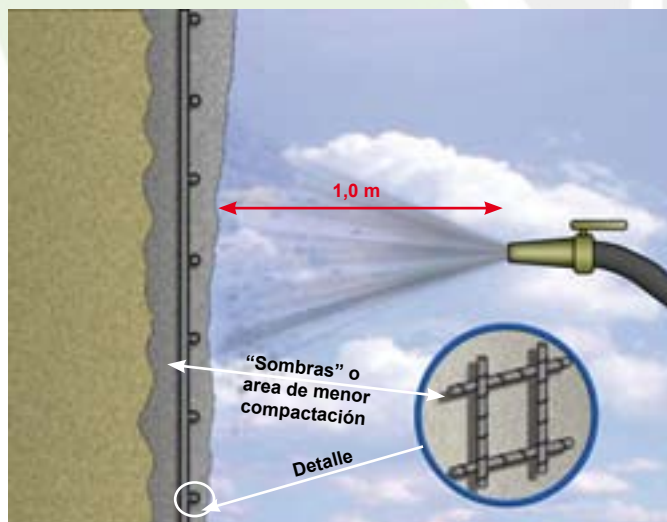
Detalle de las "sombras" en la aplicación del concreto.
